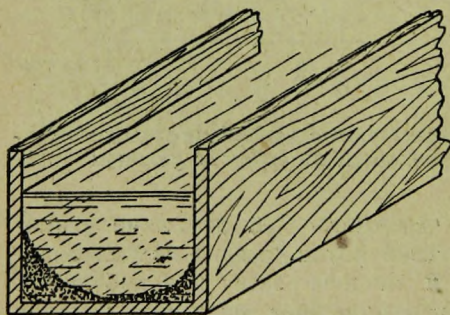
Схема образования ложа осадка в лотке прямоугольного сечения.
